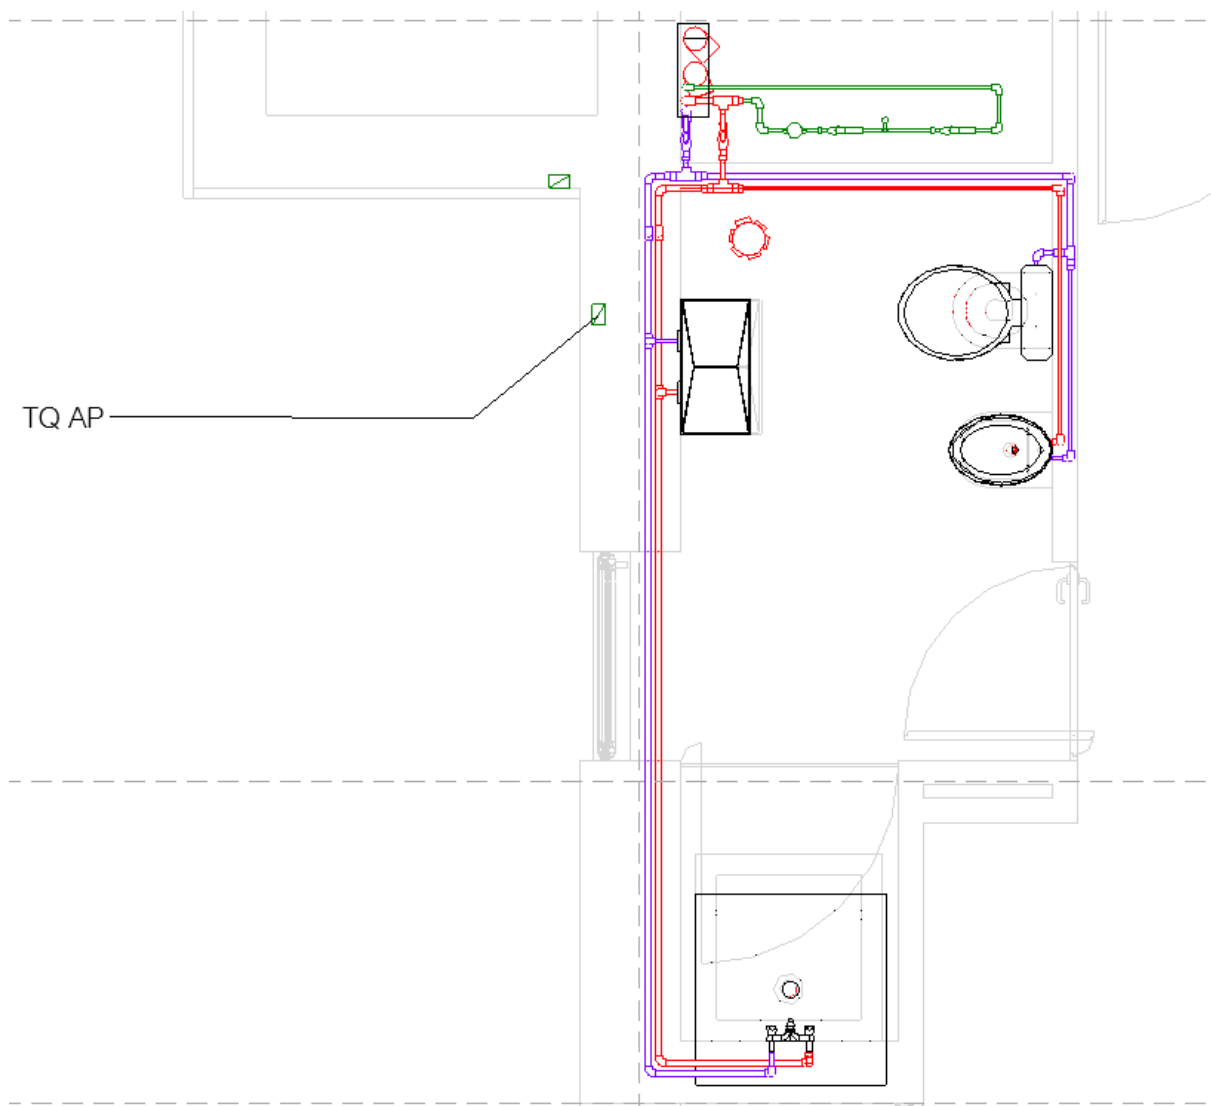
Divisão (2) em planta do piso 2 da rede predial de abastecimento
